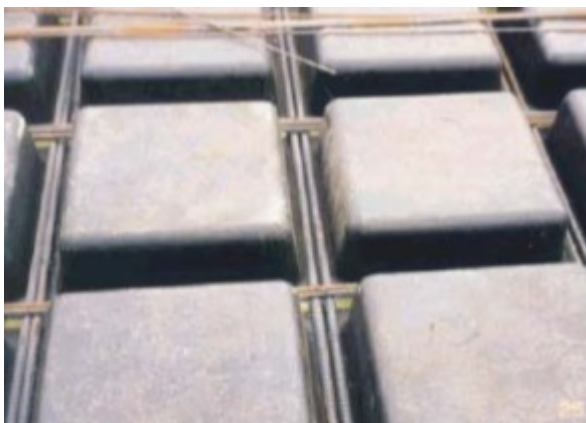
Armadura Longitudinal das Nervuras. (www.atex.com.br)
